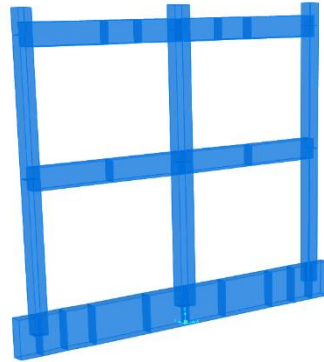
Vista geral do pórtico modelado em SAP2000 (vista em perspetiva).
